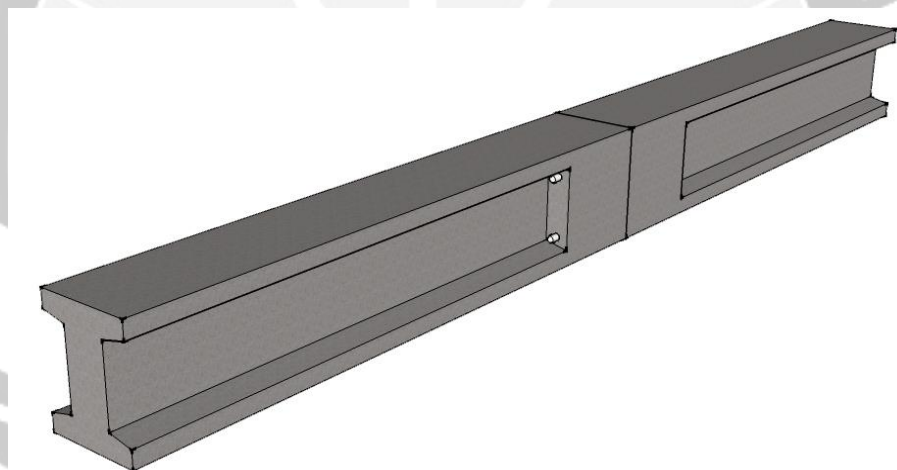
Detail Balok Tipe I (Sumber : Munaf, dkk, 2002)
